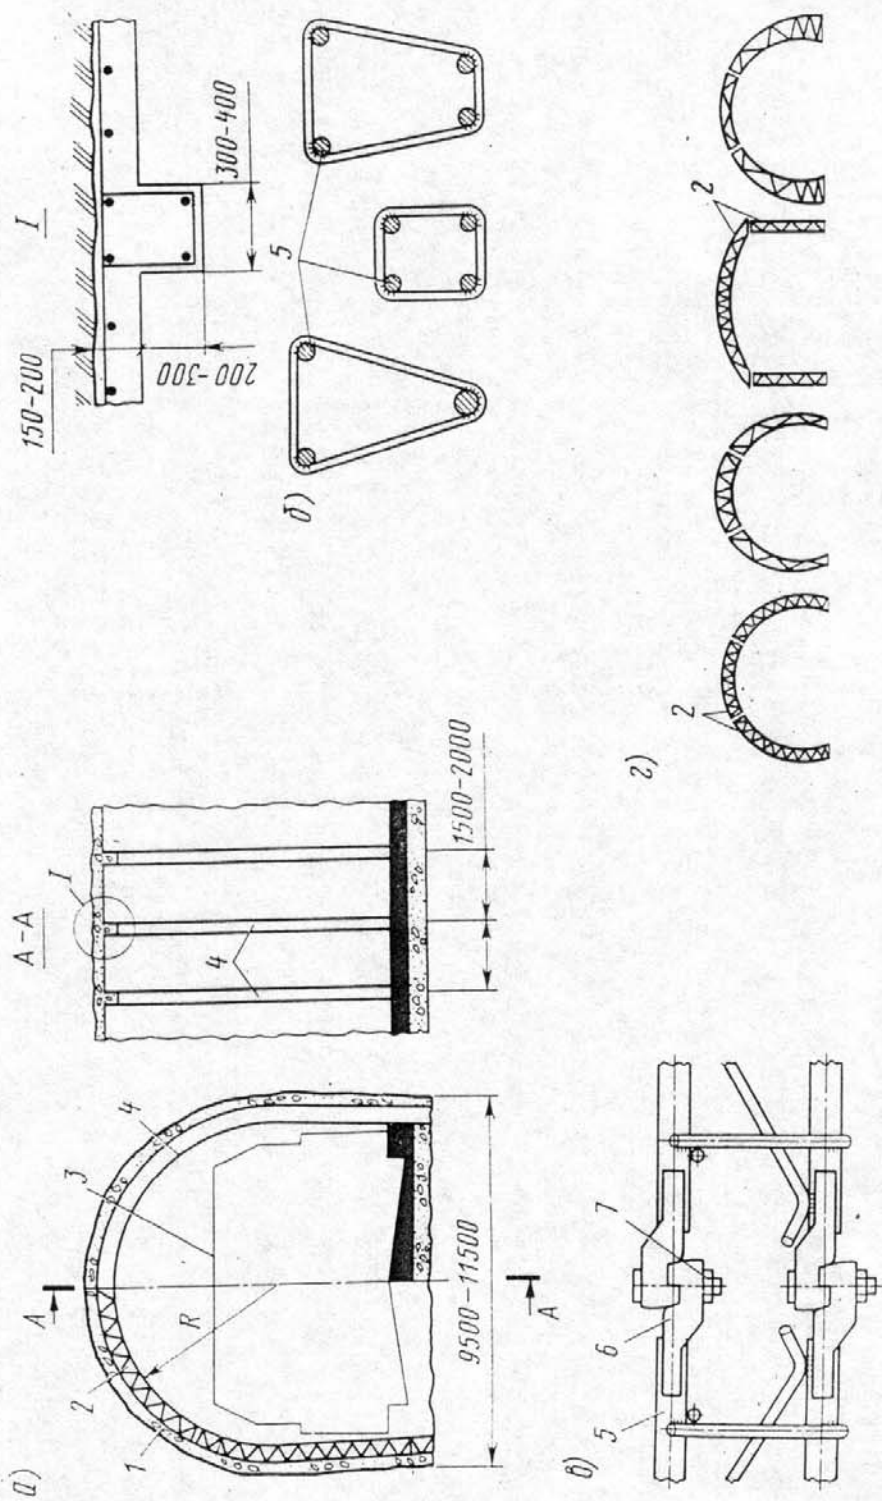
Ребристая обделка автодорожного тоннеля из набрызгбетона с решетчатыми арками и конструкции арок:
